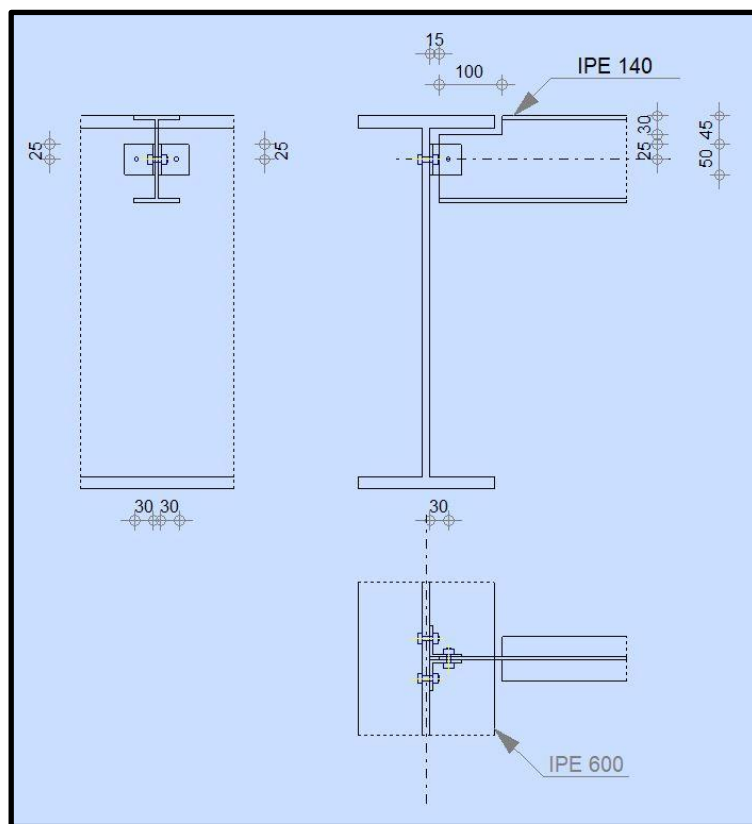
Schéma d'assemblage poutre IPE 600 – solive IPE 140
